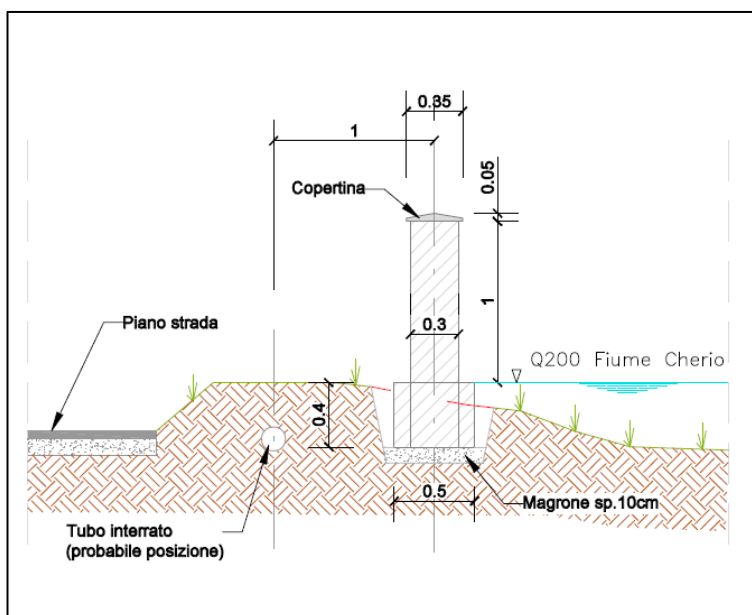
Sezioni tipo intervento muro arginale in c.a. (sponda sinistra)
